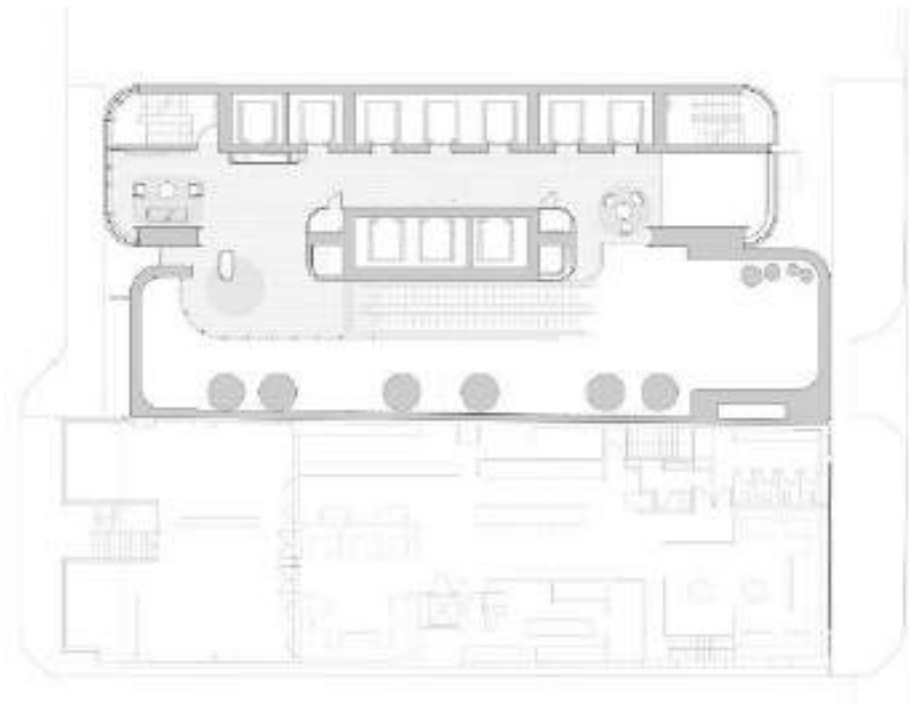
Gambar Denah Kamar 88 Walker Hotel dan Kantor
